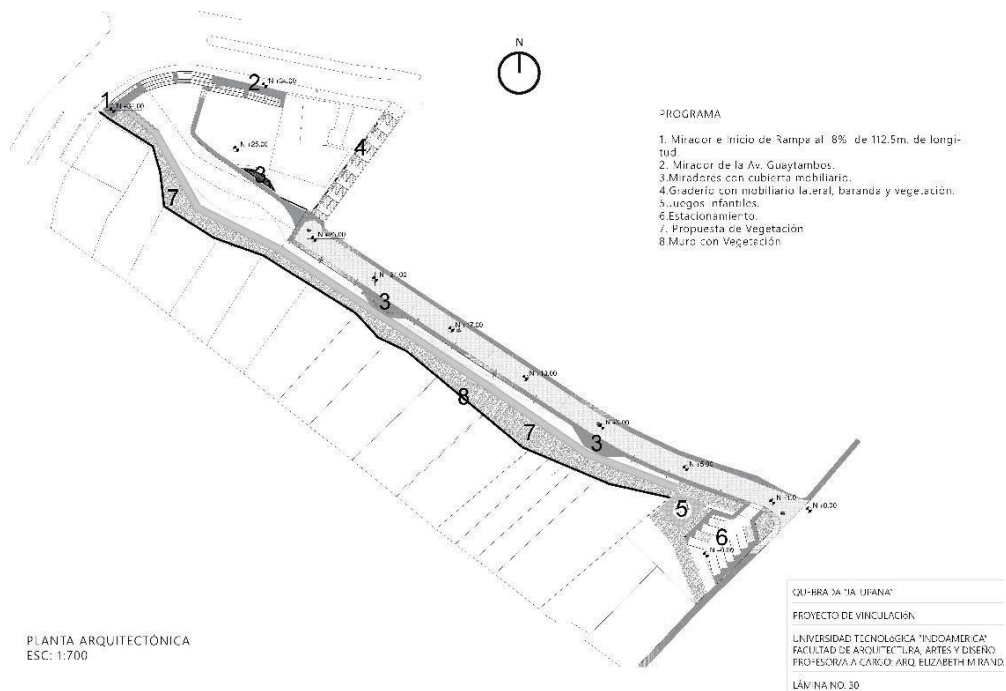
Planta arquitectónica. Fuente: Elaboración propia
